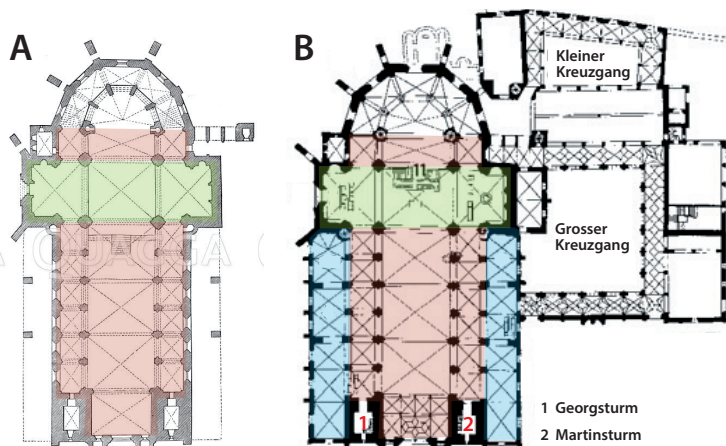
A: Grundriss des spätromanischen Münsters mit drei Längsschiffen (rot) und einem Querschiff (grün)
